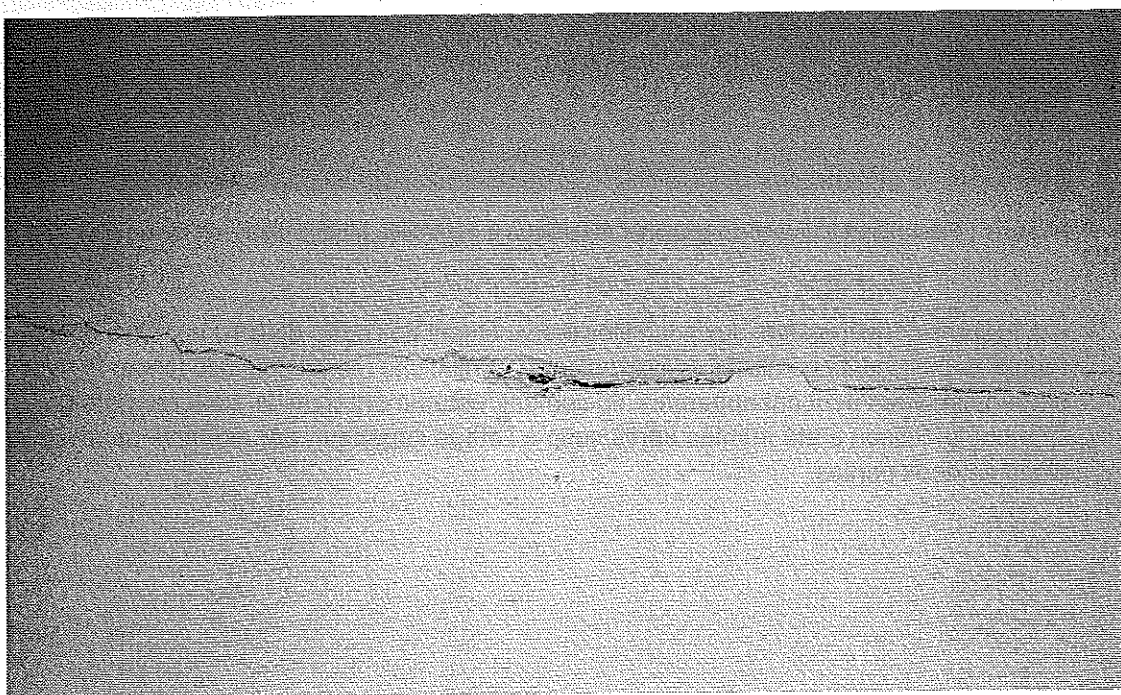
Fissure sous poutrelle métallique importante avec éclatement de l'enduit plâtre. © J. Putatti
